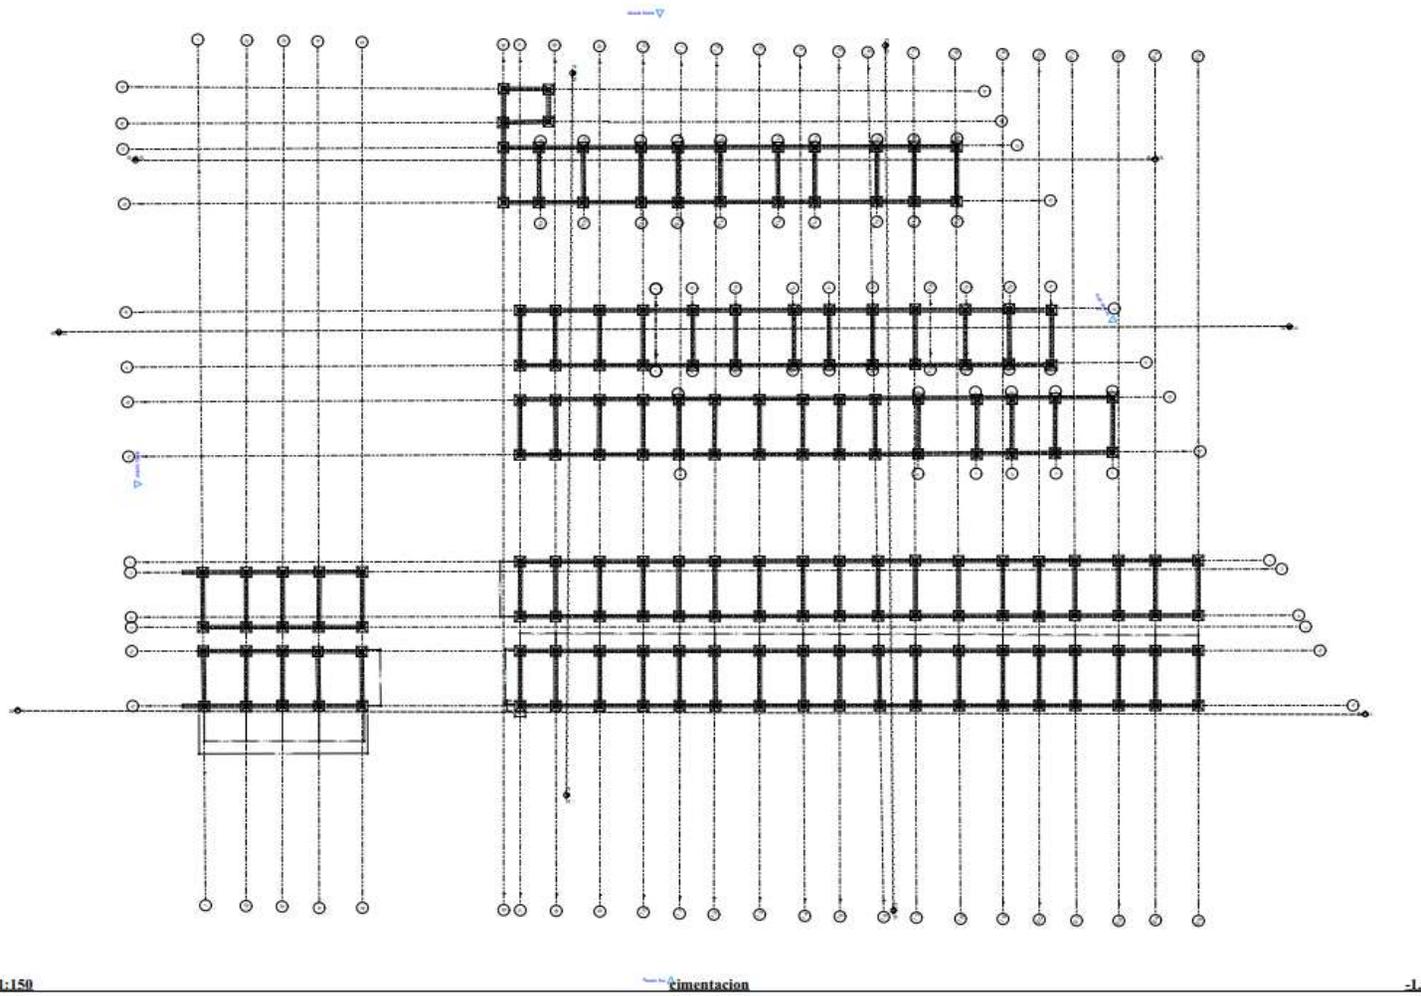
plantas fachadas cortes puesto de salud. Fuente: elaboración propia
